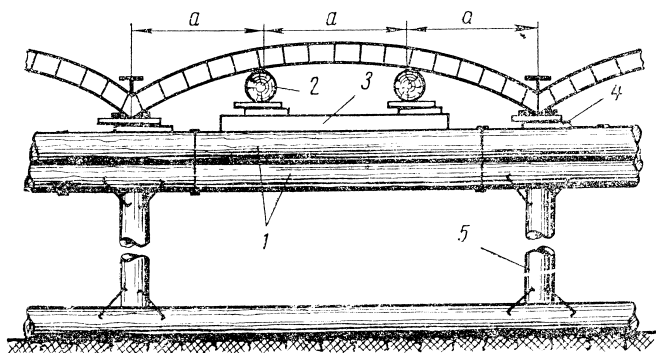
Усиление кирпичных сводчатых перекрытий:
